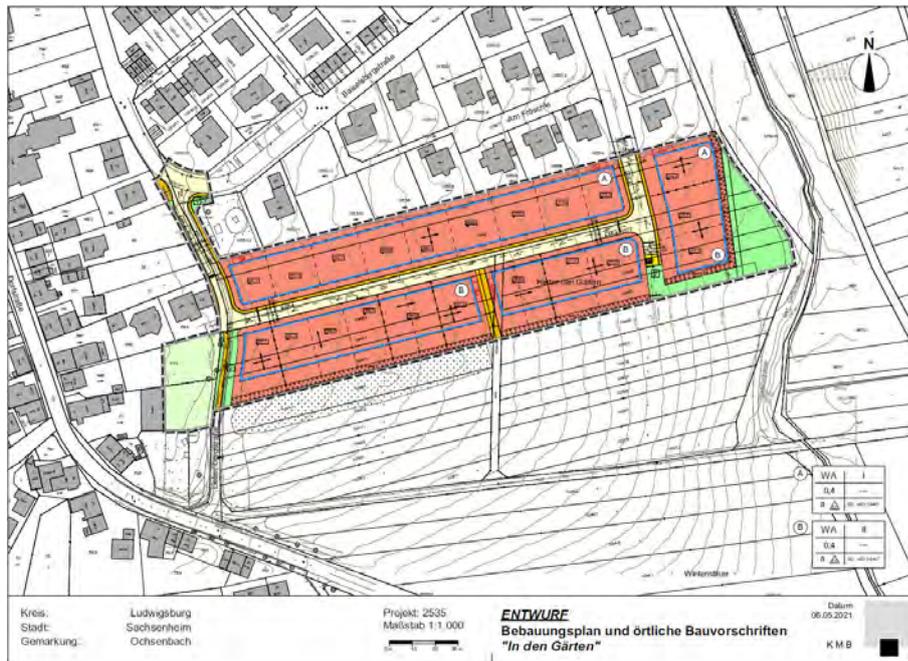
Bebauungsplan-Entwurf (STADT SACHSENHEIM / KMB PLAN | WERK | STADT GMBH, 2021)
